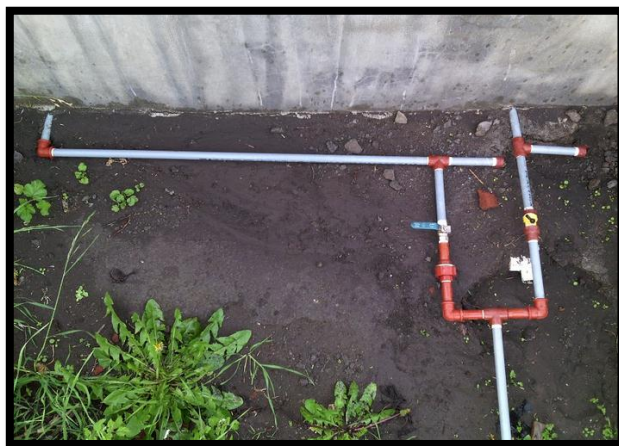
Vista Planta del sistema de drenaje por fuera del Filtro.
